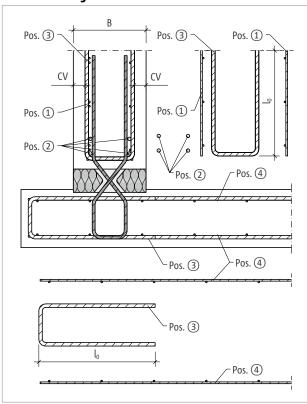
Schöck Sconnex® type W-N-VH : variante A - renforcement sur site pour le raccordement en pied de mur
